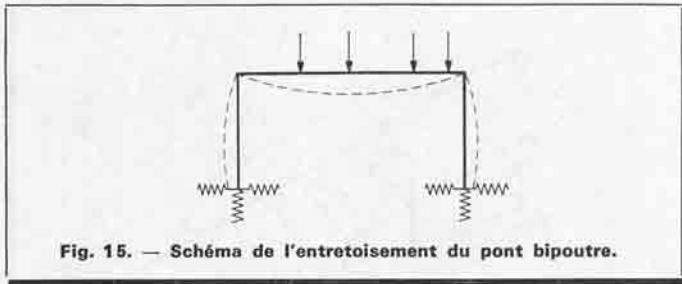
Schéma de l'entretoisement du pont bipoutre.
